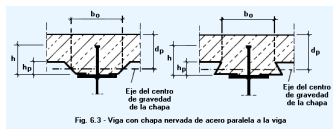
Viga con chapa nervada de acero paralela a la viga
